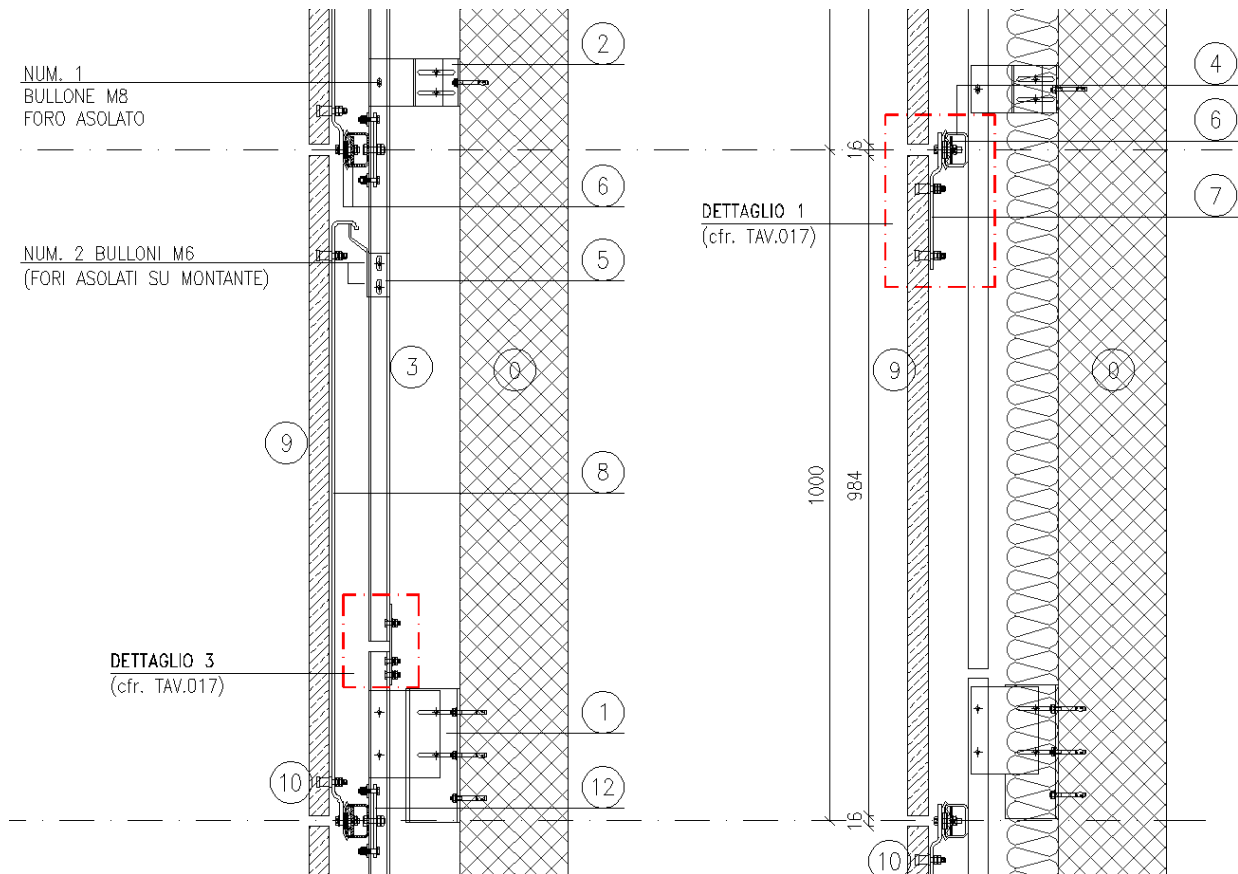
Modulo tipo sottostruttura. Vista in sezione rispettivamente su montanti (sx) e su elemento 7 (dx).
